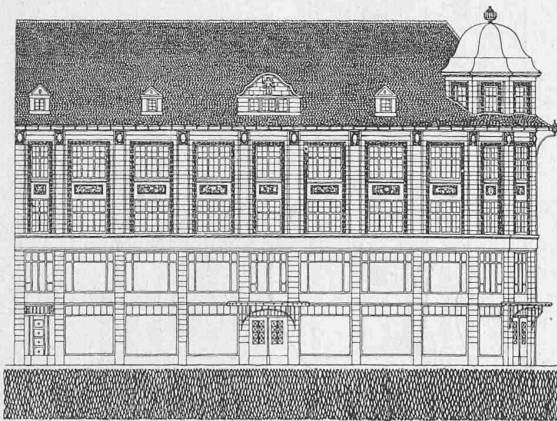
Fassade an der Nidaugasse. — Masstab 1:400.
